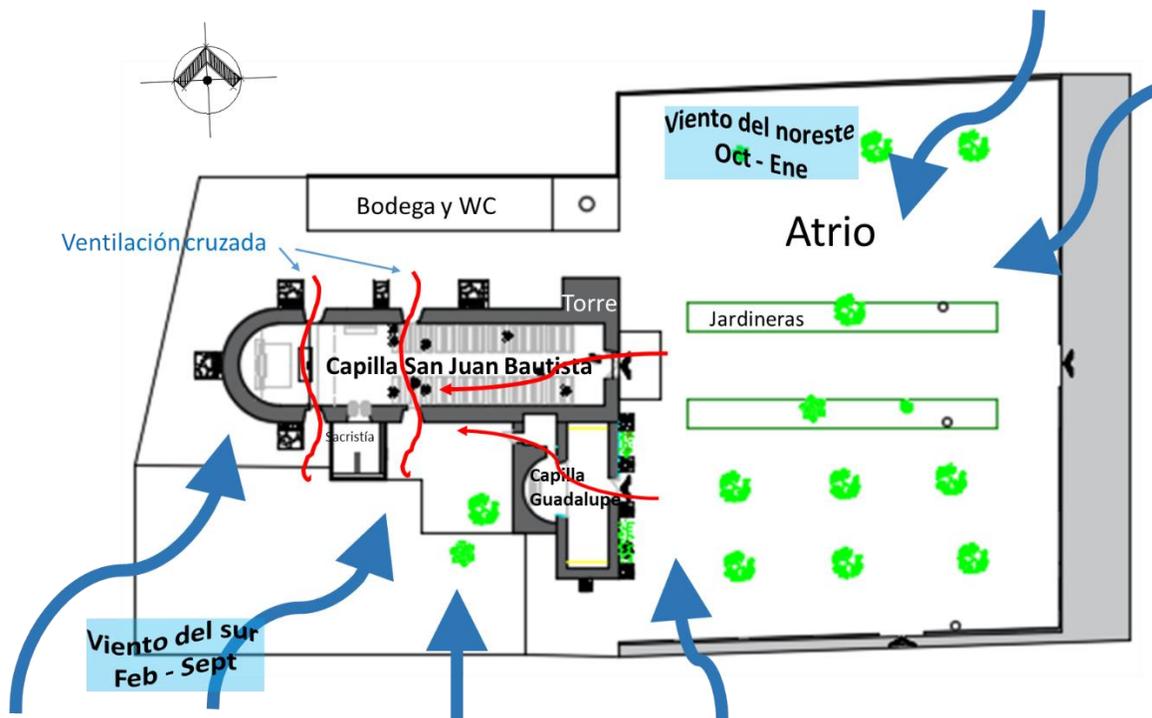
Planta arquitectónica, fachada al oriente y vientos dominantes. Fuente: elaborado por el autor con datos del SMN
